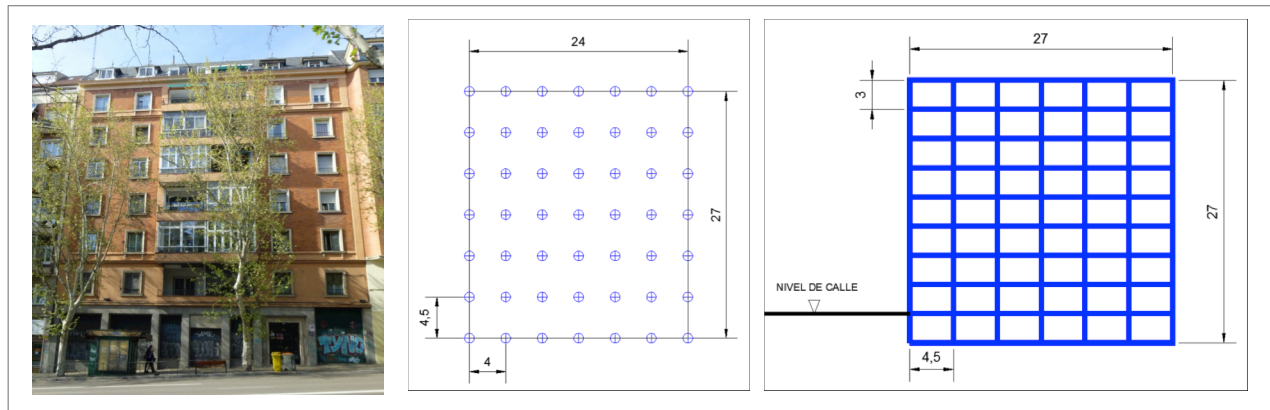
Edificio monitorizado (imagen de la fachada; planta estructural (en metros); alzado estructural (en metros))
